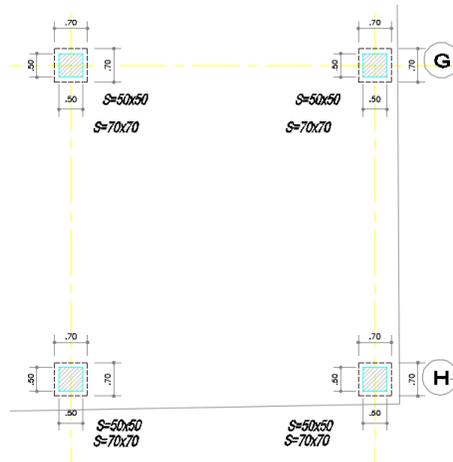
Vista parcial del plano general de columnas y pantallas entre los ejes G-H entre 1-2.
